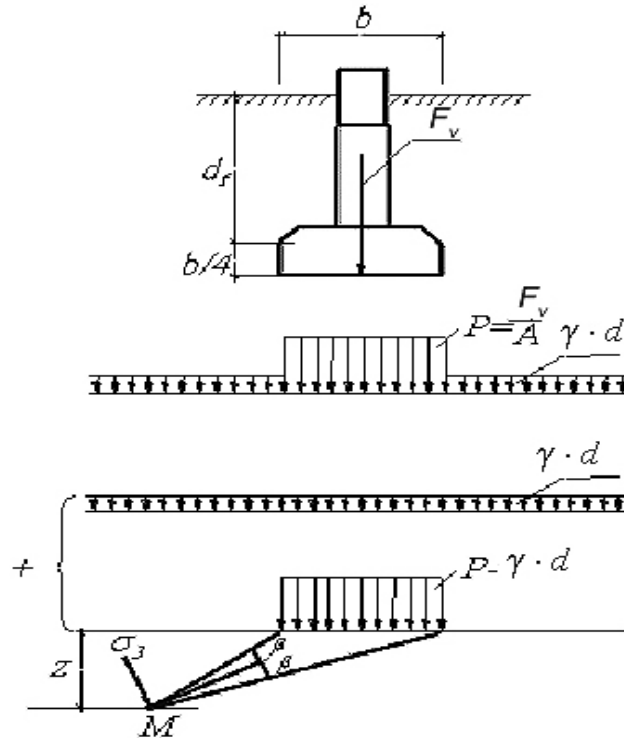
Расчетная схема к определению начальной критической нагрузки
